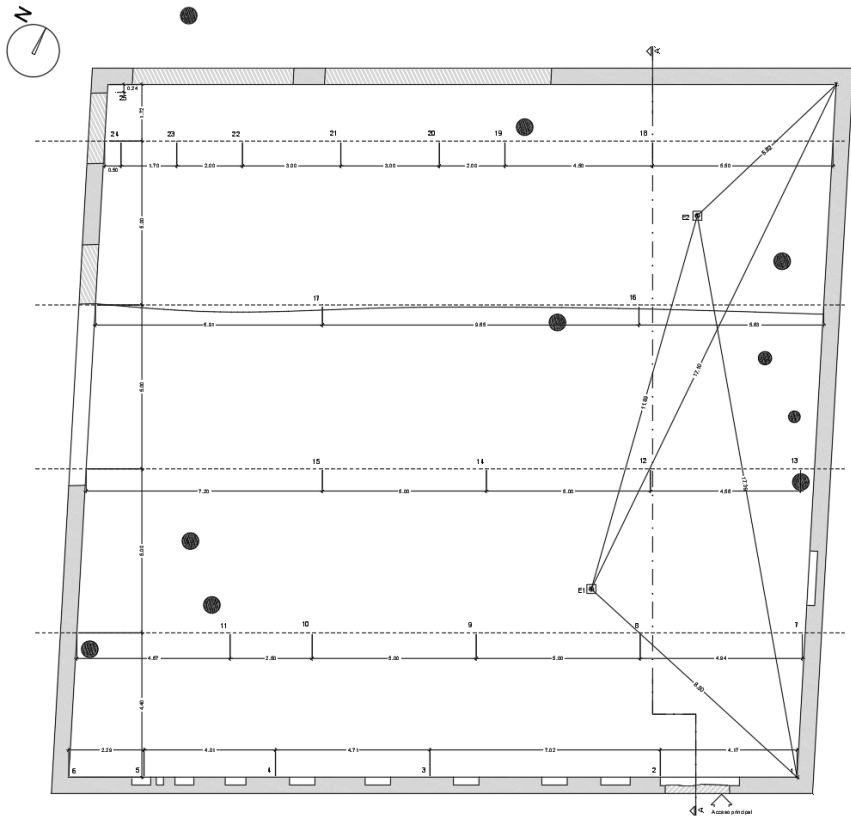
Esquema de planta aérea estado actual_ altimetría. Fuente propia.
